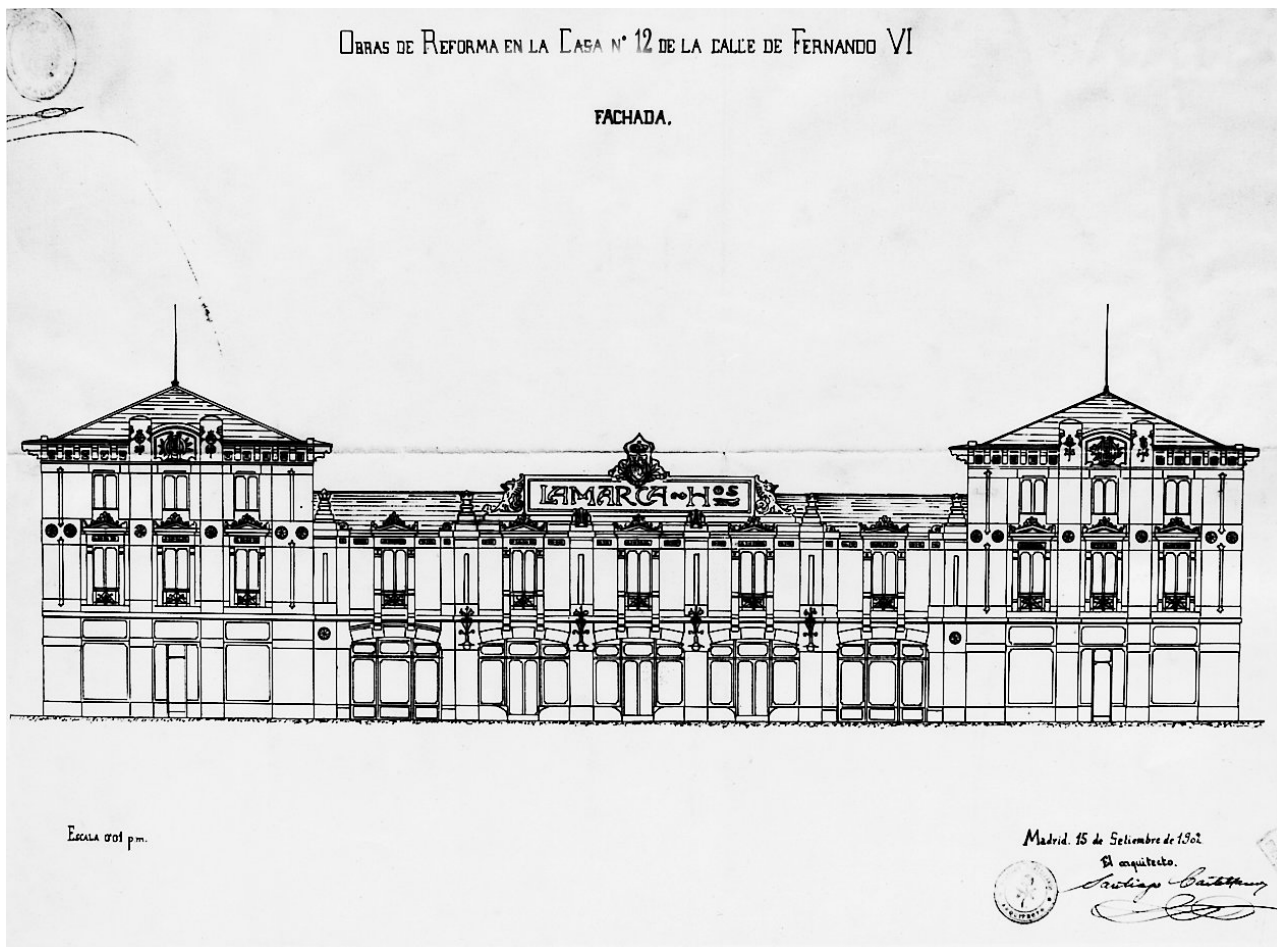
Fachada para la nueva sede de Lamarca Hnos., 1902. Arquitecto: Santiago Castellanos Urizar. AVM: 16-20-48
